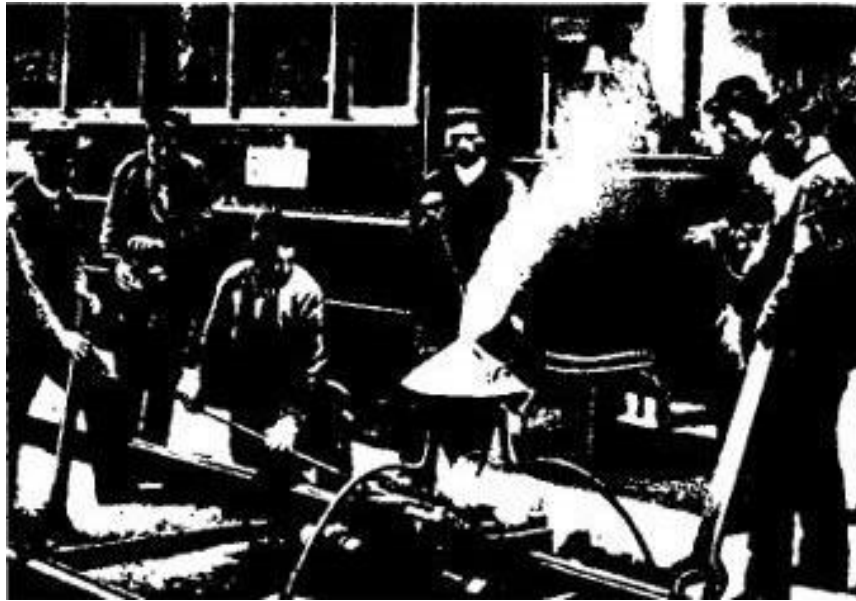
Сварка рельсов в Германии в 1899 г.
